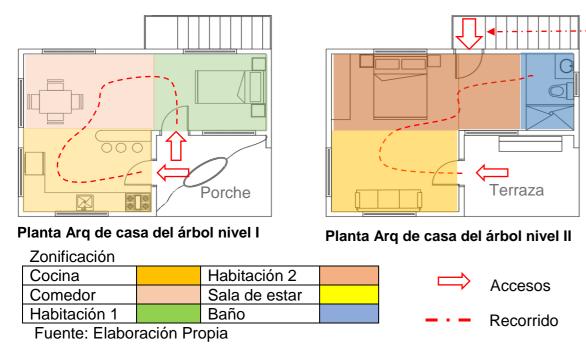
Plantas arquitectónicas de la casa del árbol. El bamboo tree house Fuente: Elaboración propia
